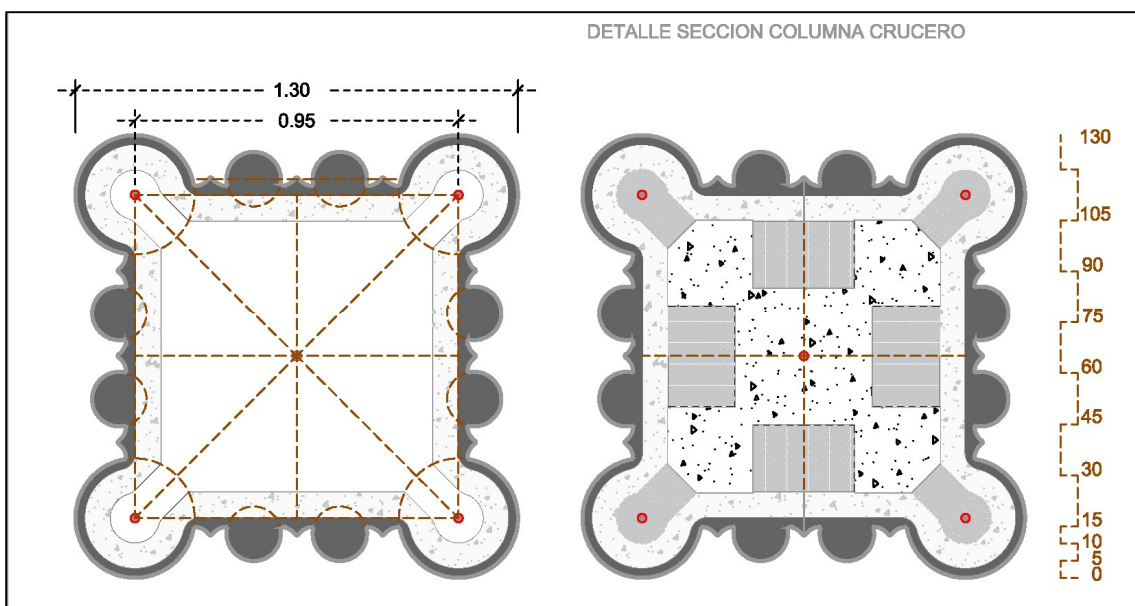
Detalle sección columna del crucero. Dibujos de Hugo A. Ventura Rodríguez.
